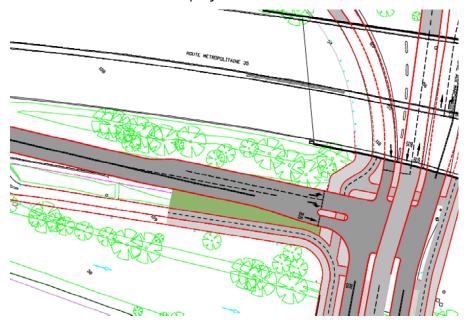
VUE EN PLAN SORTIE M35 « LES HALLES »
